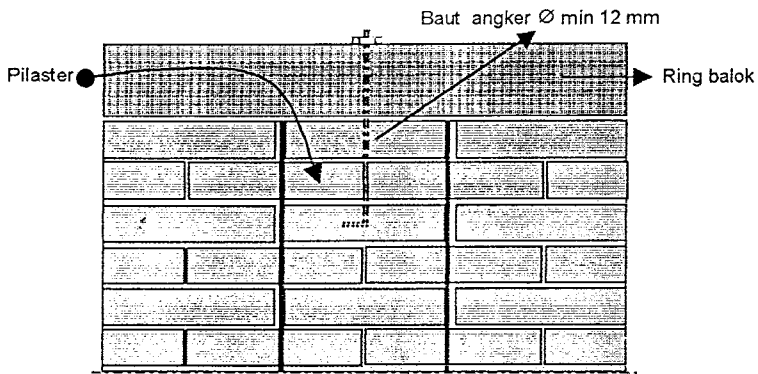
Bentuk Dinding dengan Pilaster dan Balok Lintel
